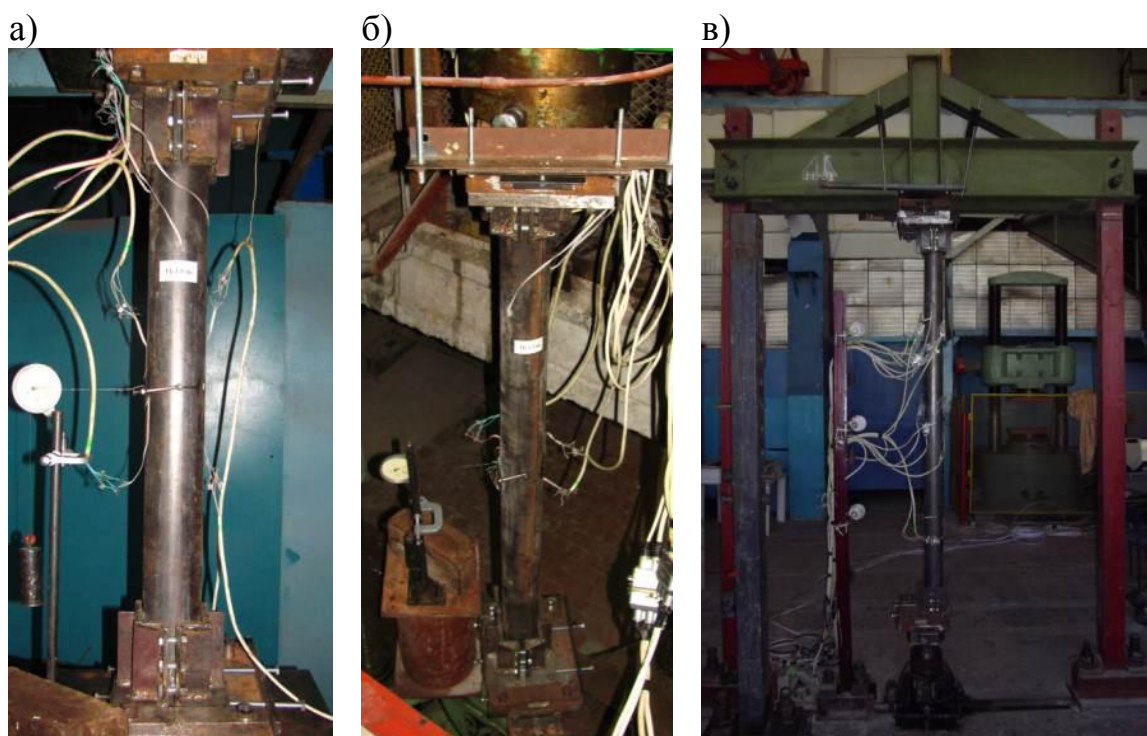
Зовнішній вигляд сталобетонних колон круглого поперечного перерізу до проведення випробувань: а - колони серії ТБ-1.0-1, б - колони серії ТБ-1.5-1, в - колони серії ТБ-2.0-1.
